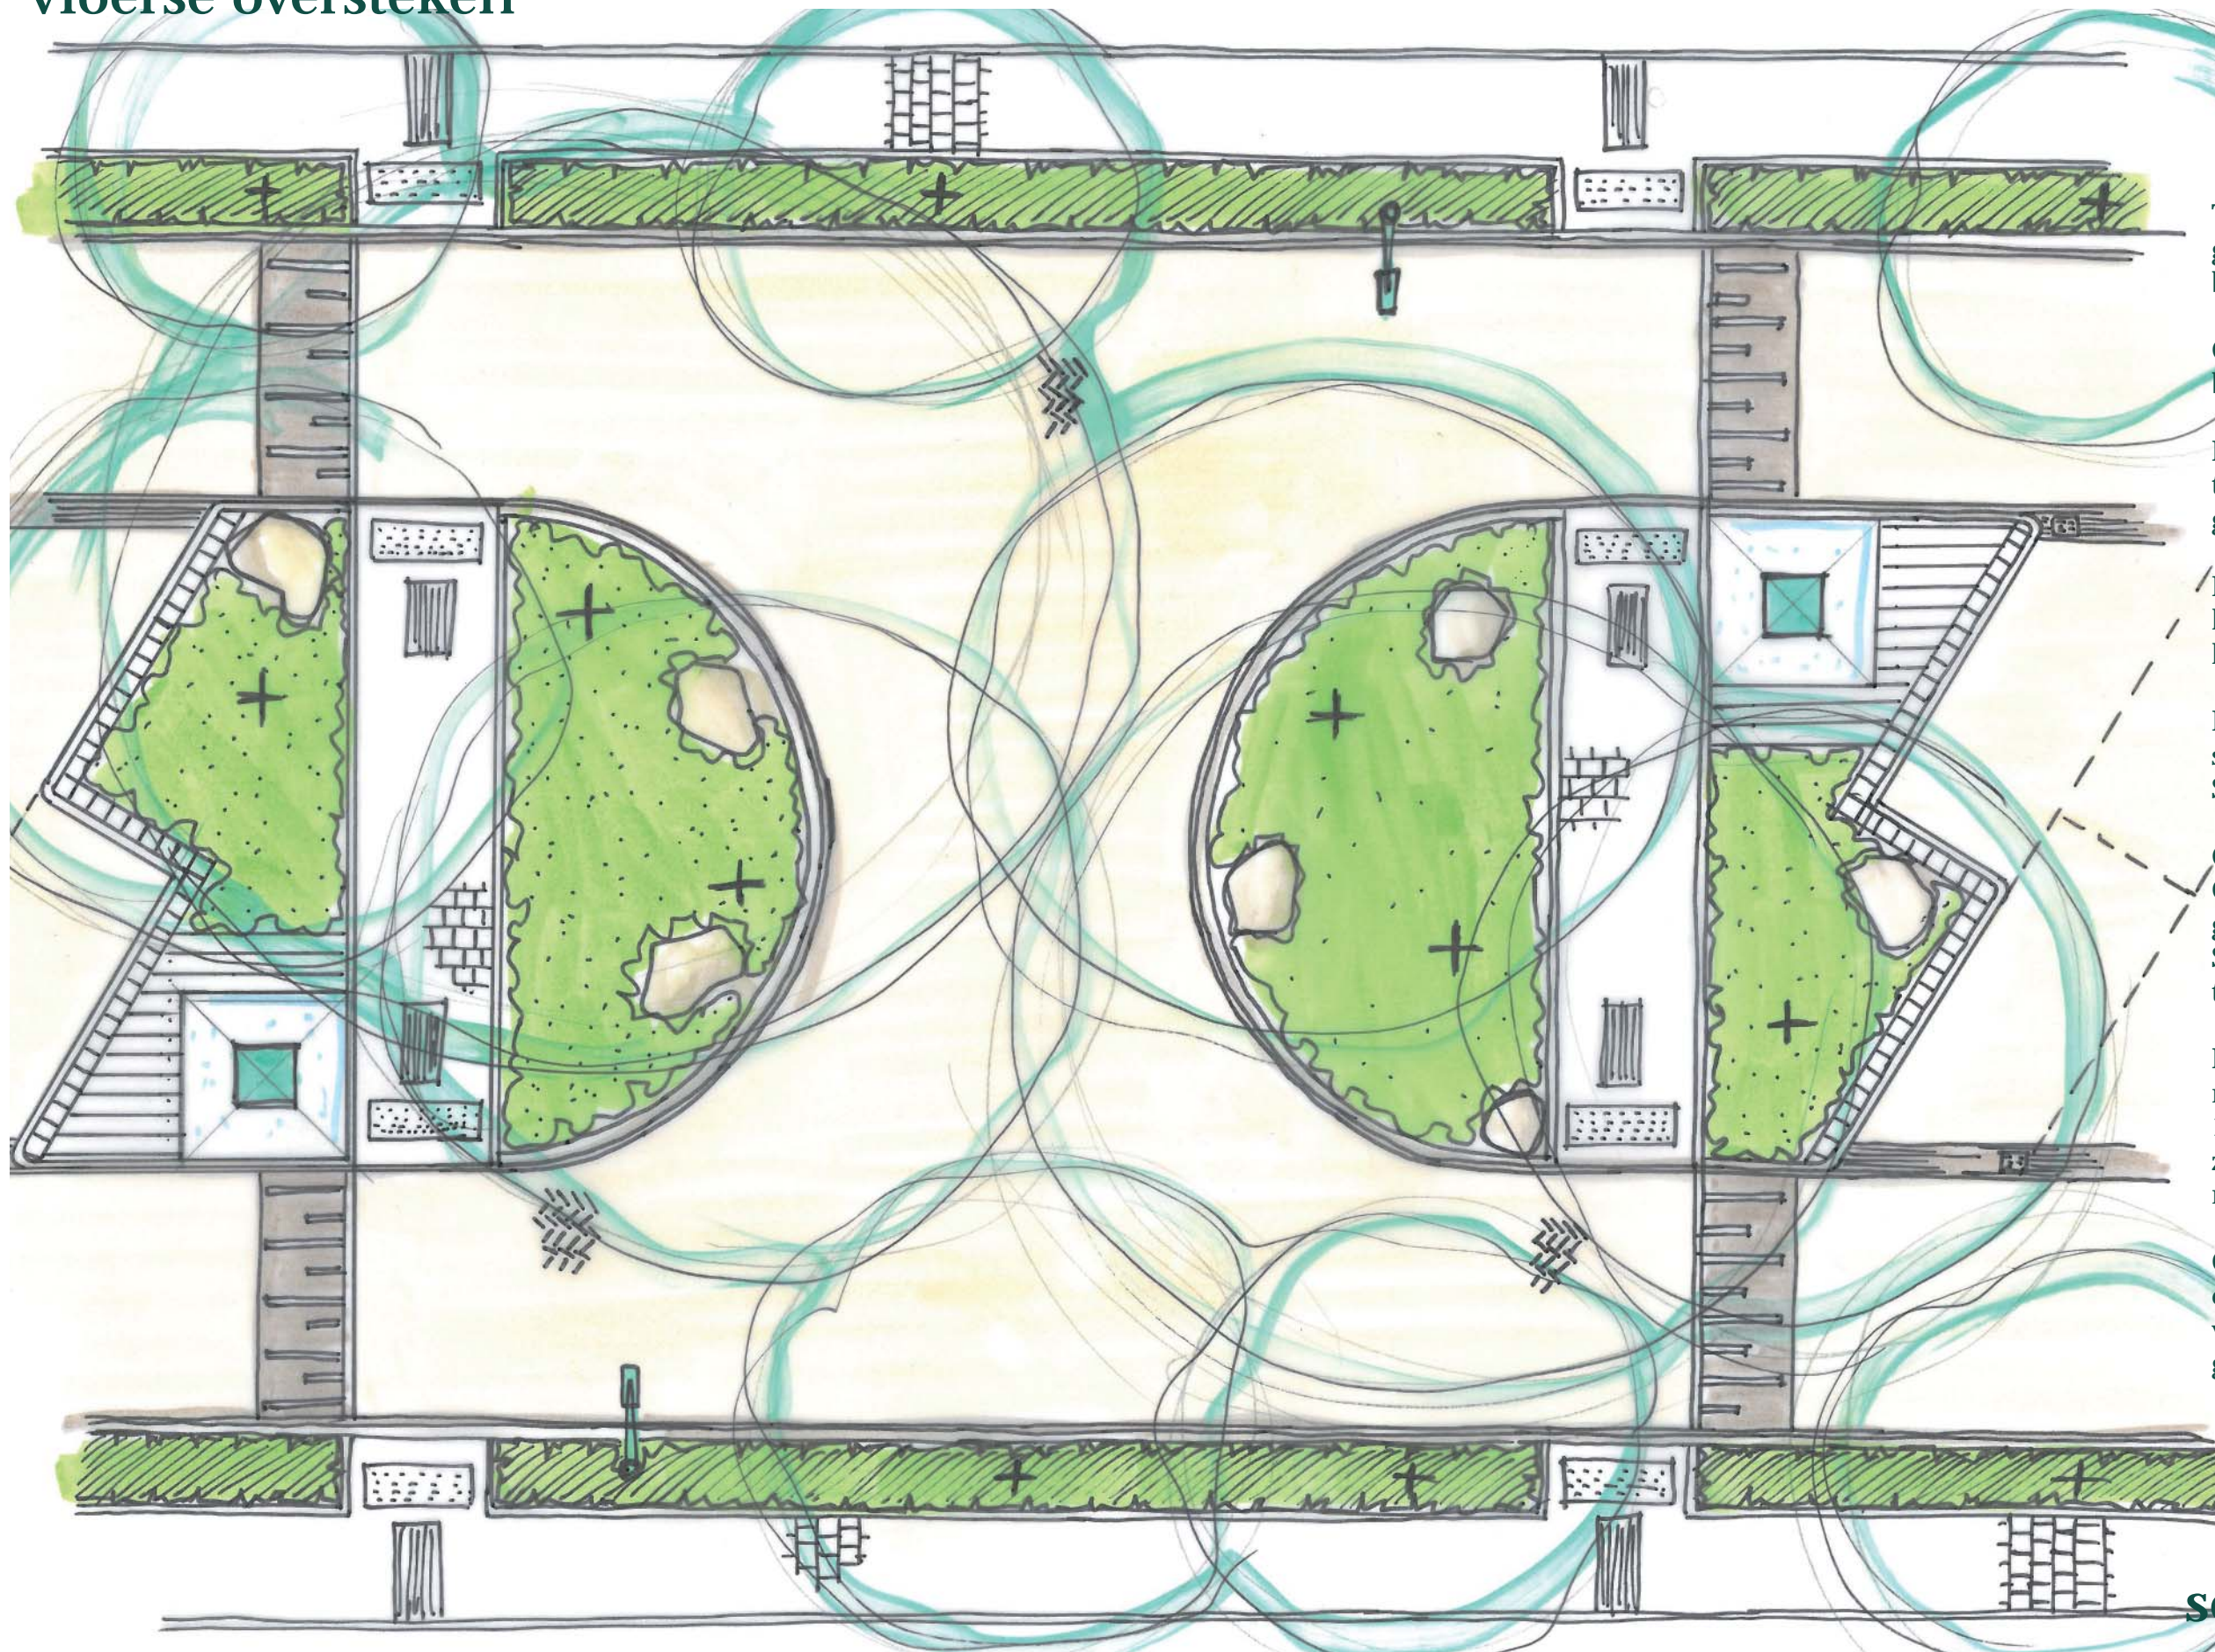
Inritconstructie van Minckelersstraat naar buurtontsluitingsweg
